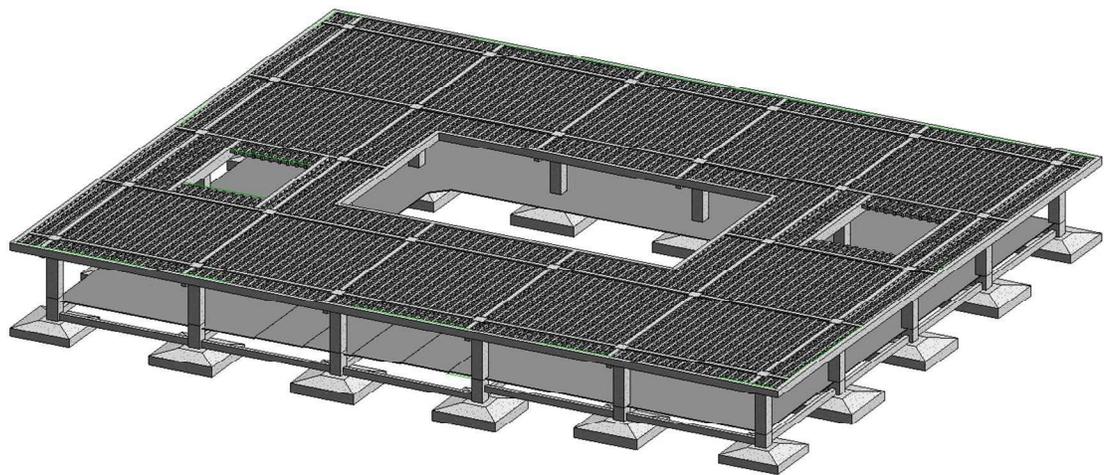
Sistema de vigas en dirección vertical y horizontal en losa
